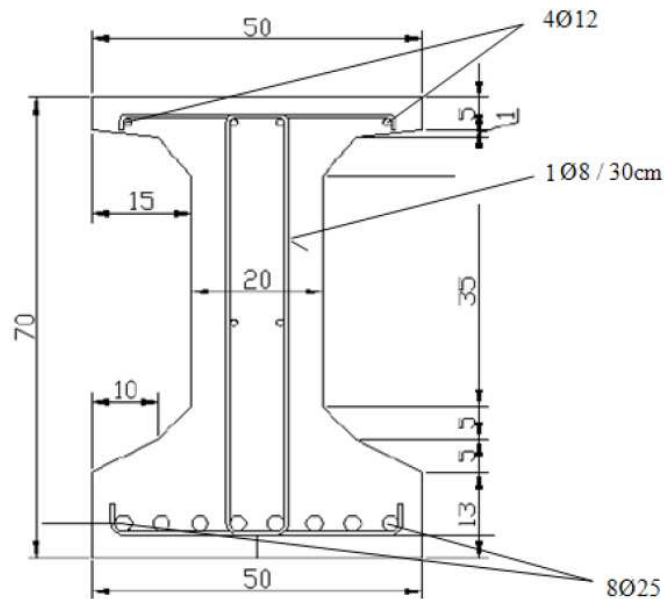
Geometria da seção transversal (dimensões em cm) e armaduras das vigas (diâmetros em mm) (CUENCA *et al.*, 2009, p.2922).
